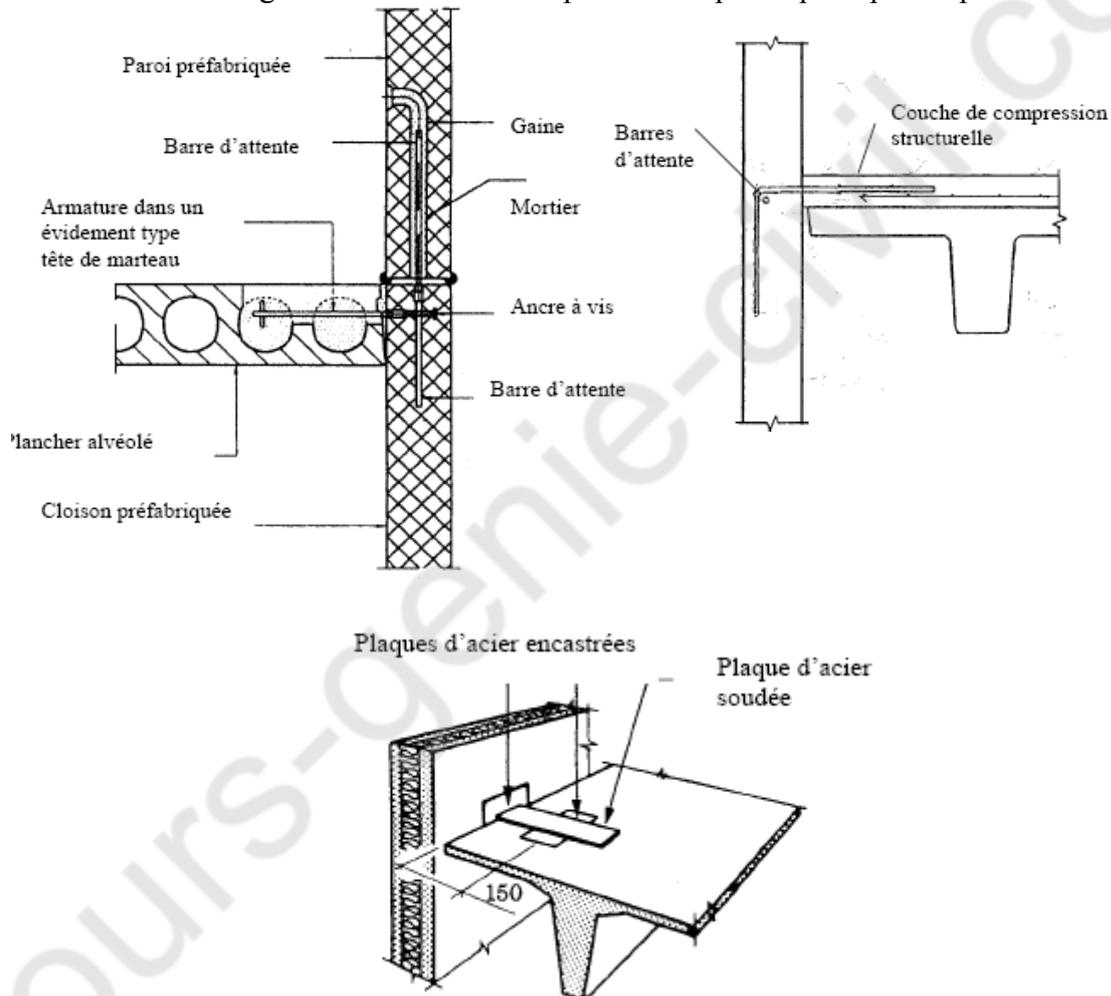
Assemblages aux bords latéraux des planchers alvéolés et planchers TT
